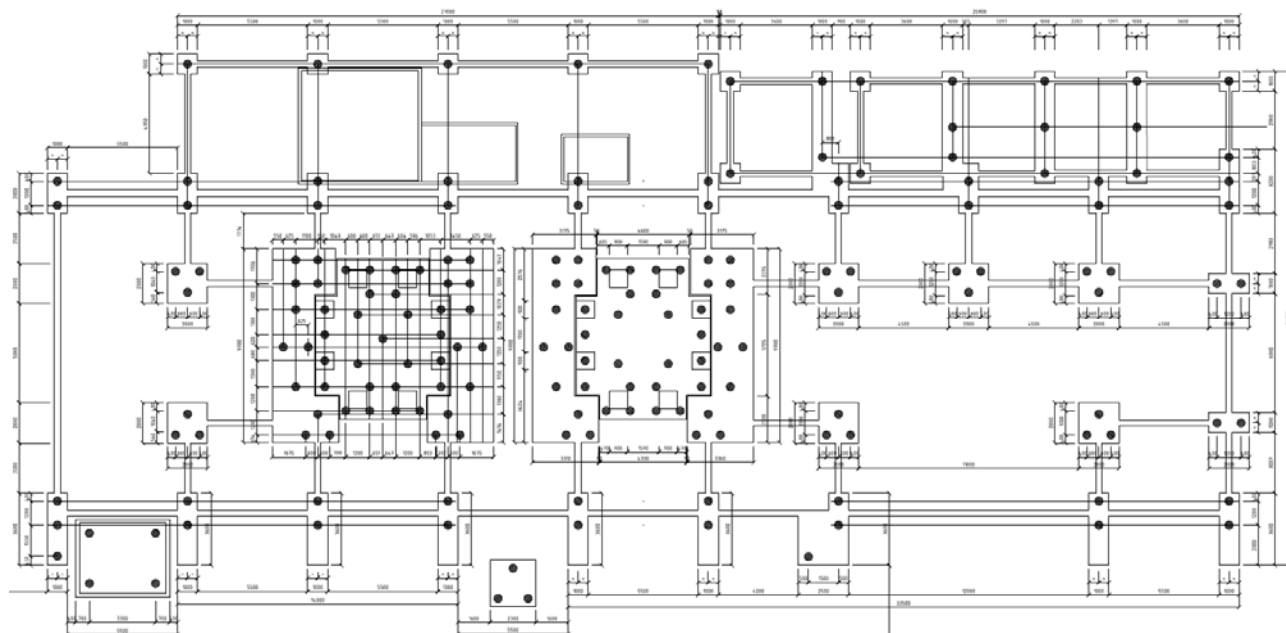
Vista in pianta delle fondazioni del capannone e dei forni.
